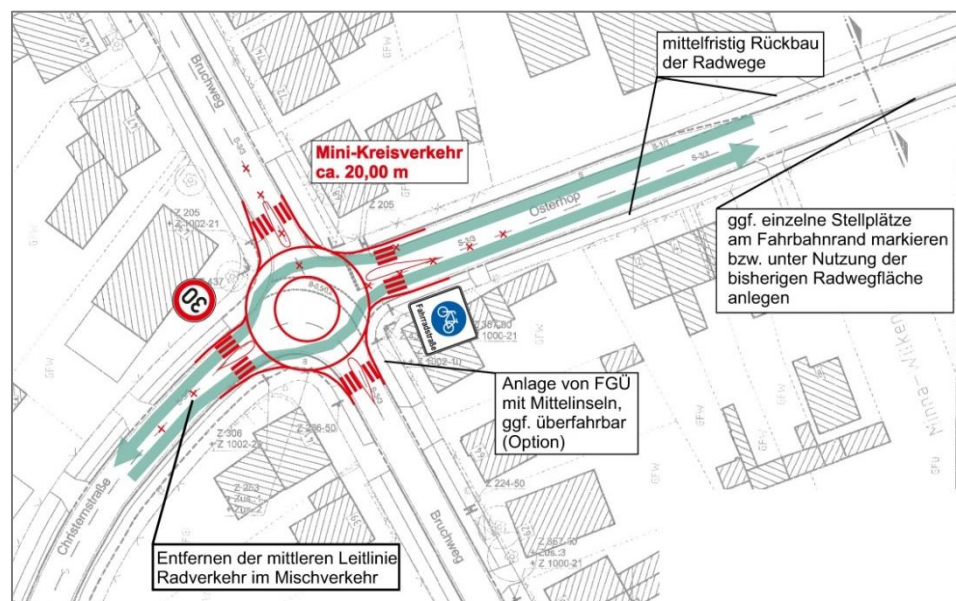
Knotenpunkt Christernstr./Bruchweg: Umbau eines Minikreisverkehrs anstelle einer abknickenden Vorfahrtbeziehung
